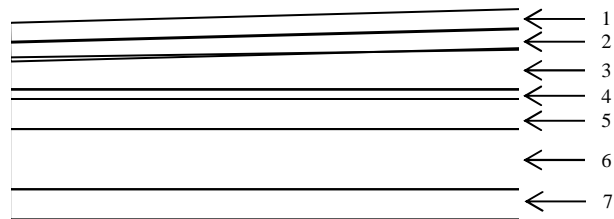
Coupe transversale du plancher terrasse inaccessible
